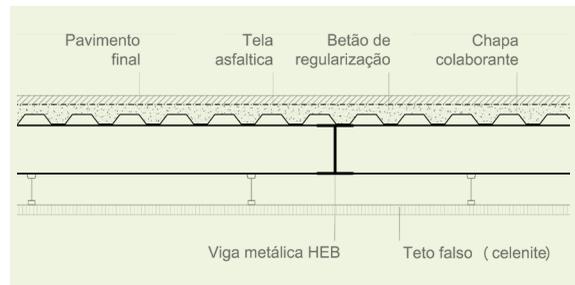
Reforço de paredes através de vigas metálicas. Fig. 26. Laje colaborante a substituir a antiga laje de betão armado. Fig. 27. Corpo do edifício no alçado posterior com o vigeamento todo substituído. Fig. 28. Revestimento do pavimento a soalho. Fig. 29. Revestimento do teto a celenite.
